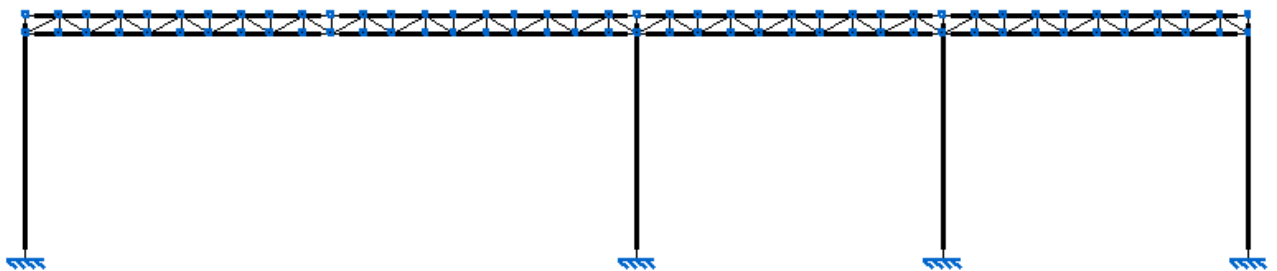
Geometría Modelo CYPE 3D – barras Vista Este
